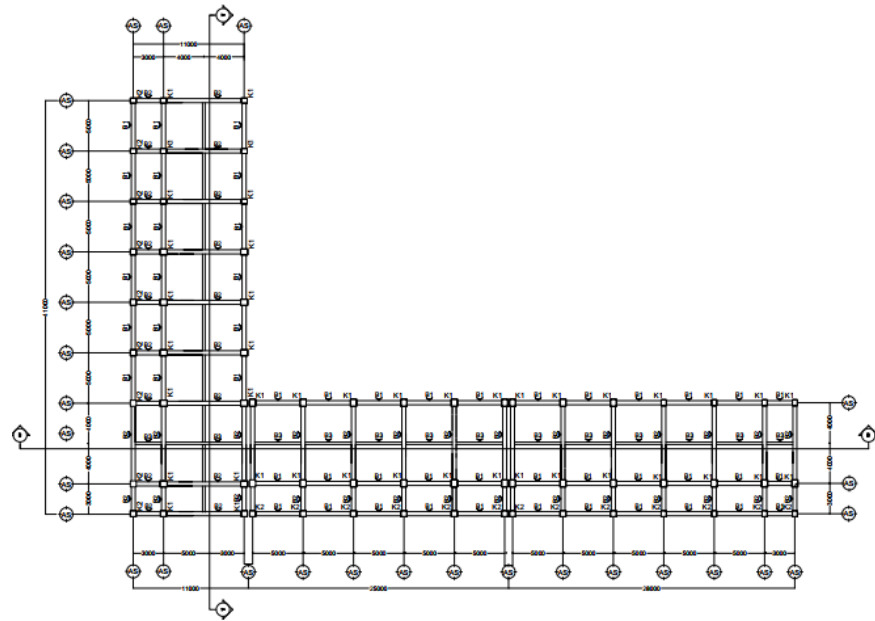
Rencana Balok dan Kolom Lantai 1
